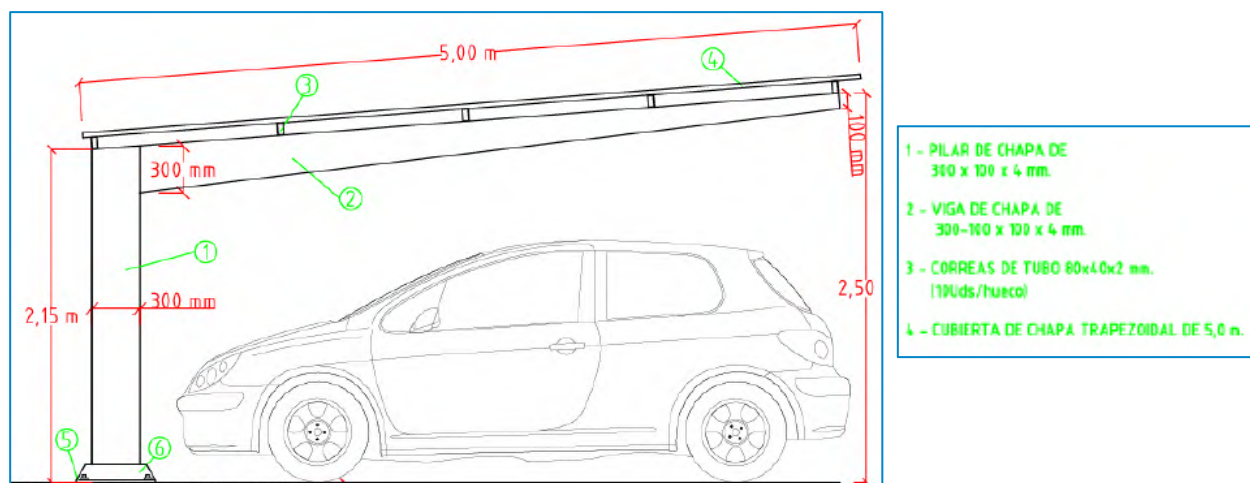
Estructura de montaje de marquesina de aparcamiento
